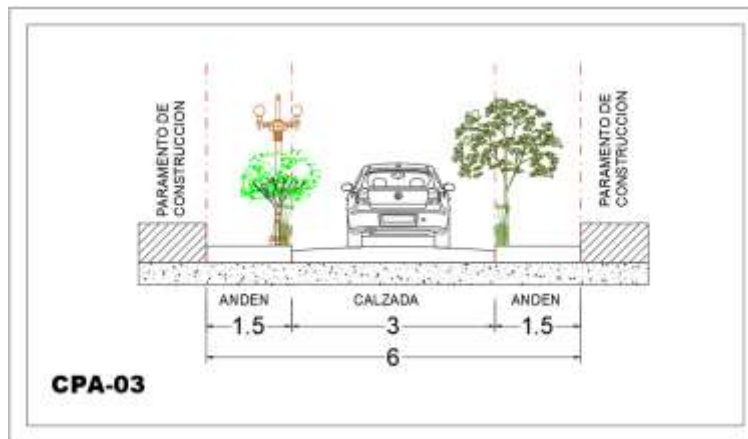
Perfil vial CPA-03 especial para el centro Poblado La Aguadita.
